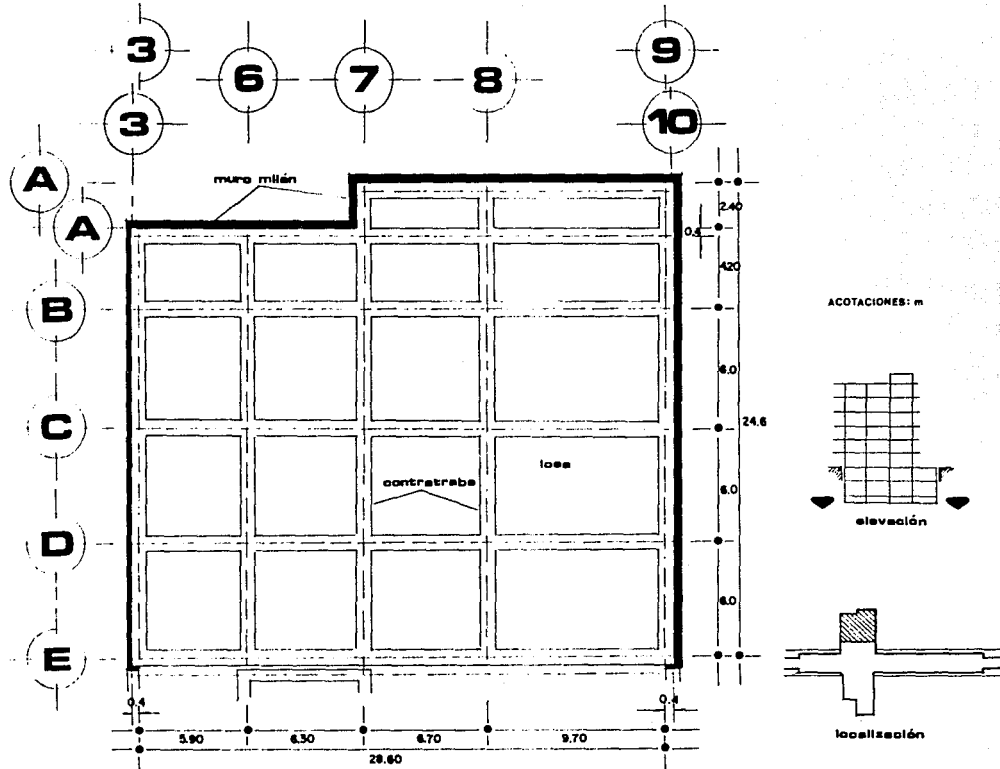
PLANTA DEL NIVEL CIMENTACION
